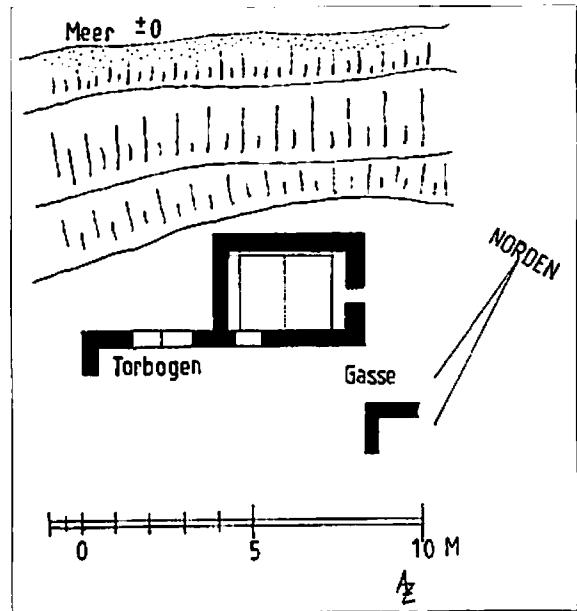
Kalabatia*, casa con porta ad arco - planimetria. / *Kalabatia*, Haus mit Torbogen - Grundriß.
